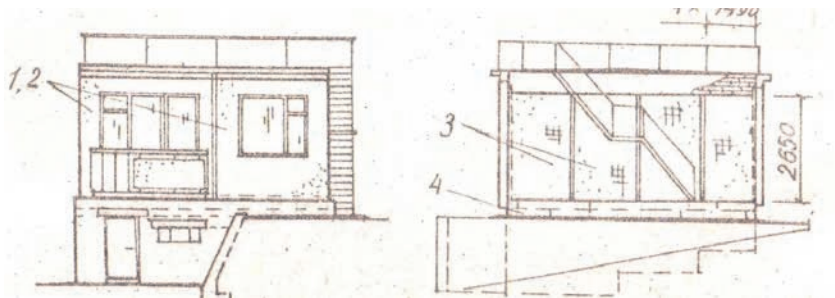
Садовый домик с применением стеновых панелей и плит перекрытий:
